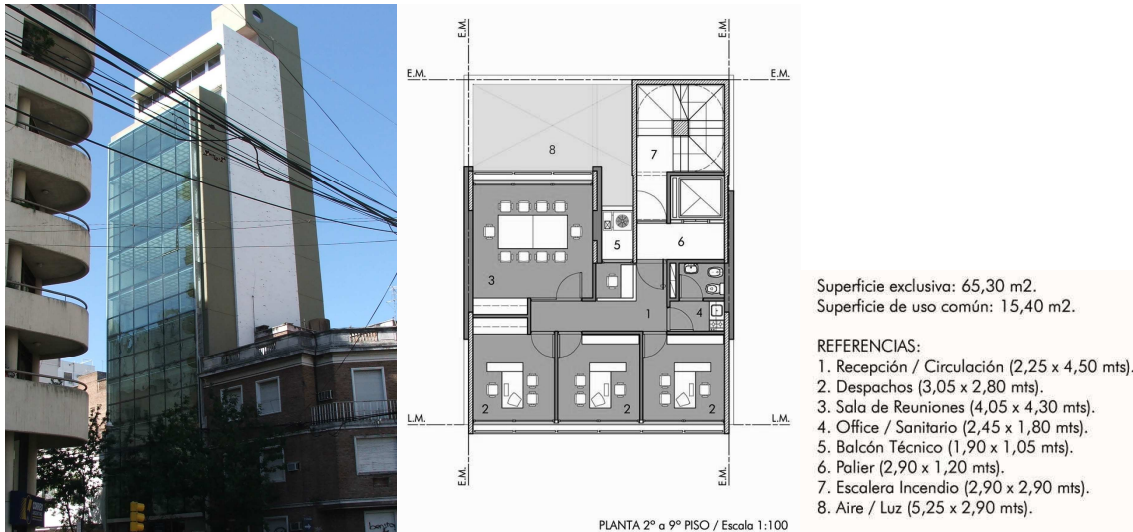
Edificio de Oficinas Los Surcos. Planta tipo y Fachada principal orientada al Oeste.
